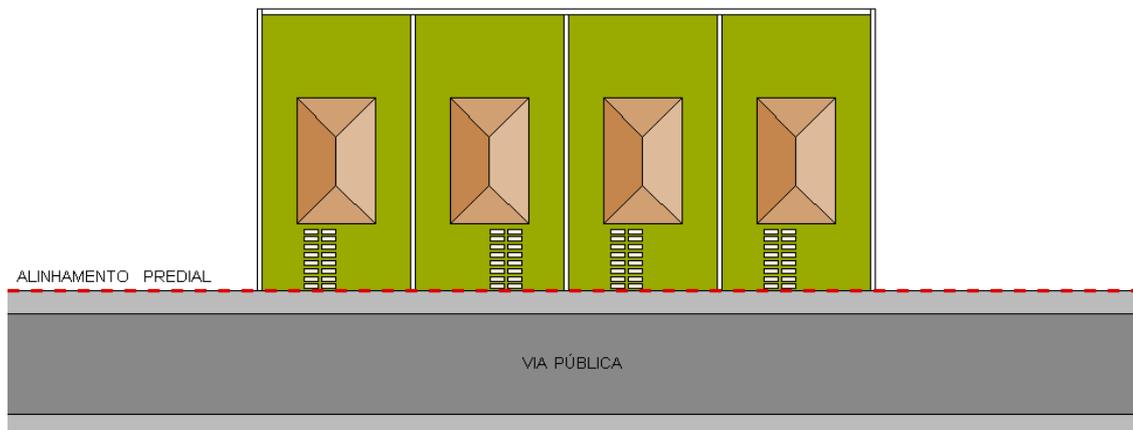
Planta esquemática de habitação familiar em série – paralela ao alinhamento predial
